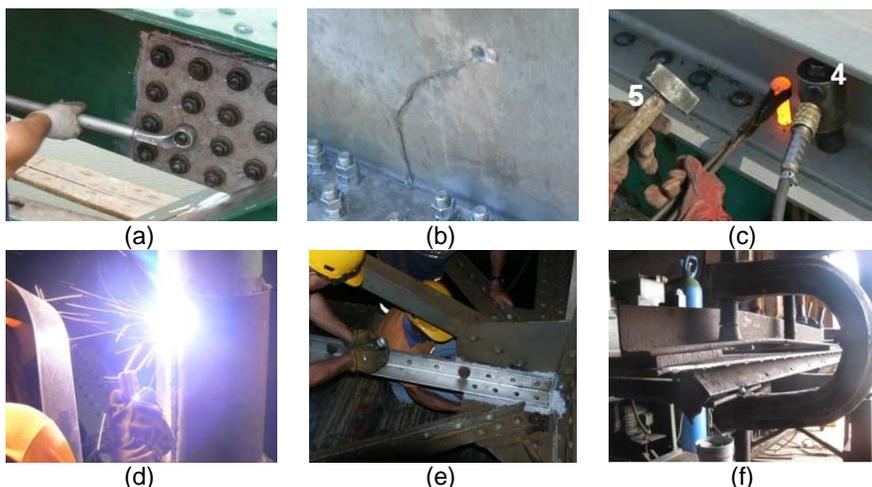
Exemplos de métodos de reparação: (a) Aparafusamento; (b) *Stop hole*; (c) Rebitagem; (d) Soldadura; (e) Substituição de elementos; (f) Endireitamento mecânico.
